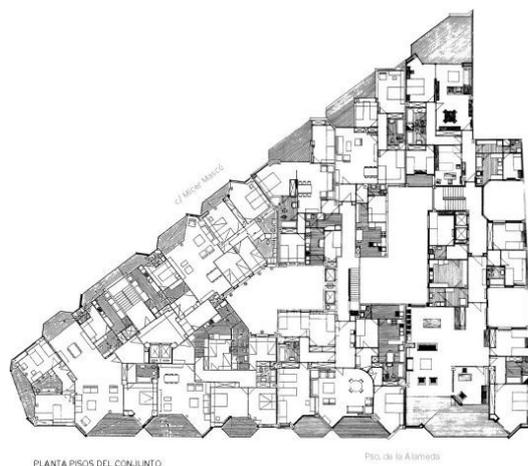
Planta tipo del Edificio de viviendas en la Alameda. Fuente: CTAV
